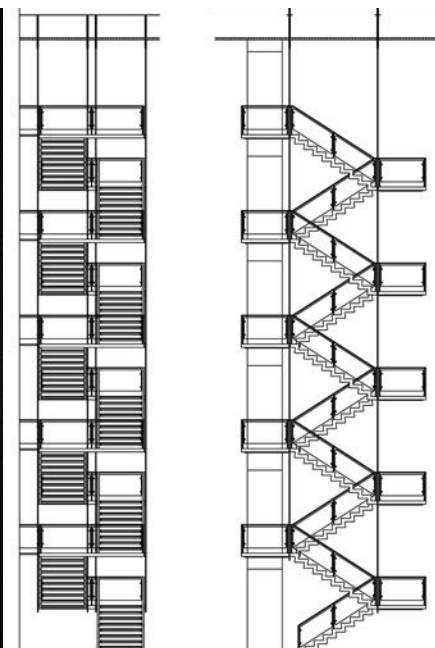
y 27. Ayuntamiento de Rødovre. A. Jacobsen. Escalera, planta y alzado.
